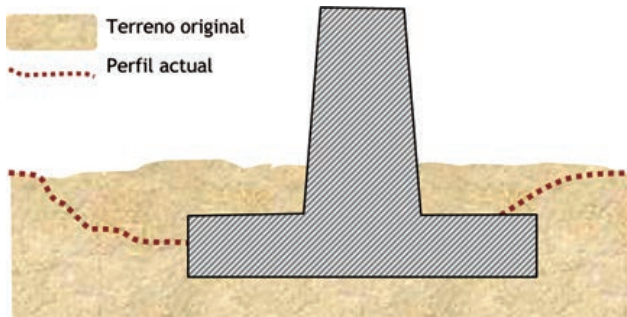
SOCAVACIÓN FUERTE EN PILA.
